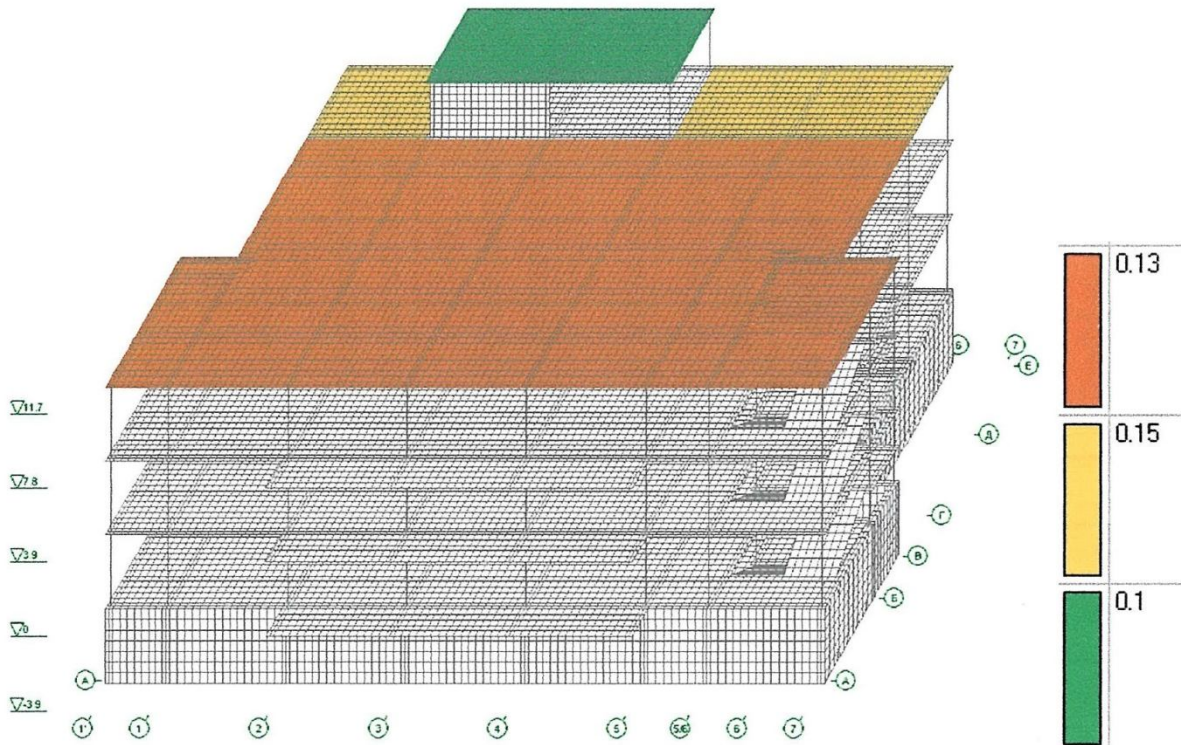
Схема завантаження б – Навантаження від снігу 1, т/м<sup>2</sup>
